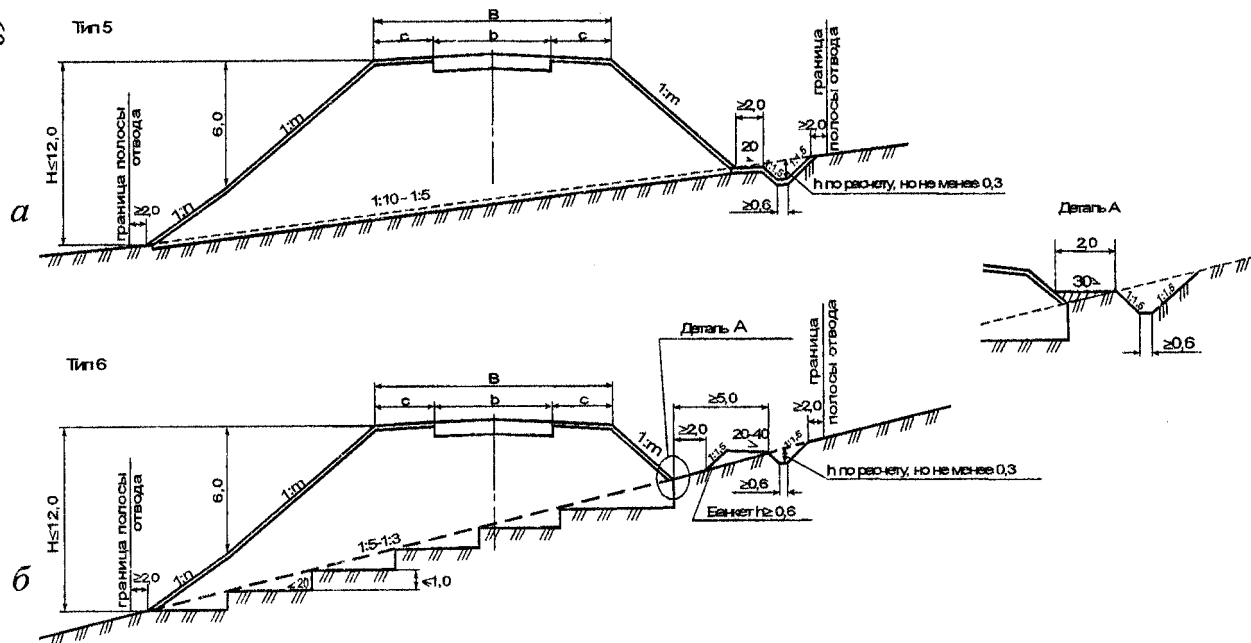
Поперечный профиль земляного полотна в насыпи на косогорах:
